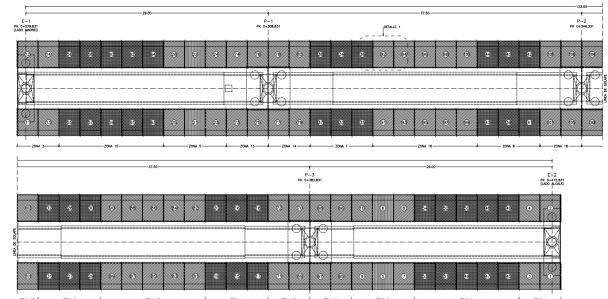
Secuencia de izado y retirada de voladizo de la losa superior
